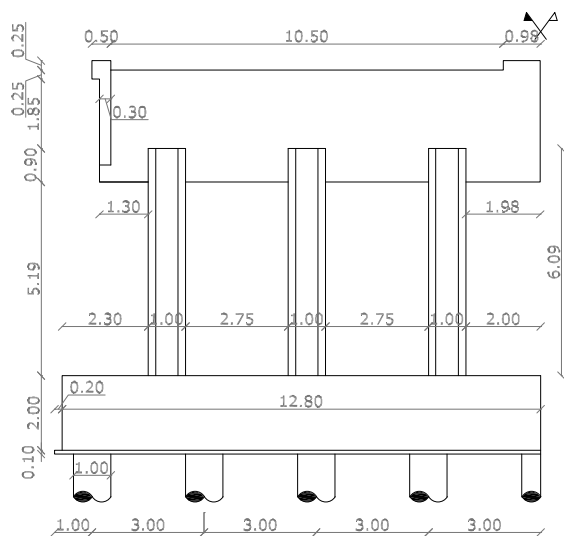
Vista laterale dei ritri della spalla.
